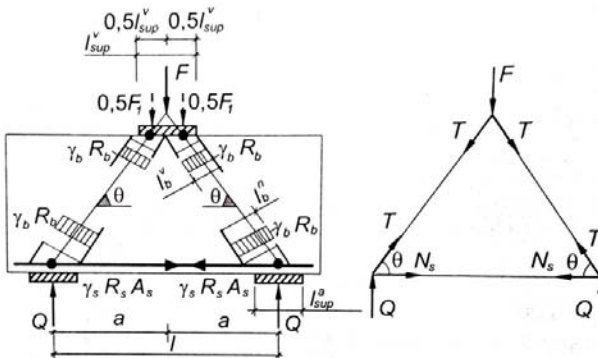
Расчетная модель и схема усилий в коротких элементах (на примере короткой балки)
